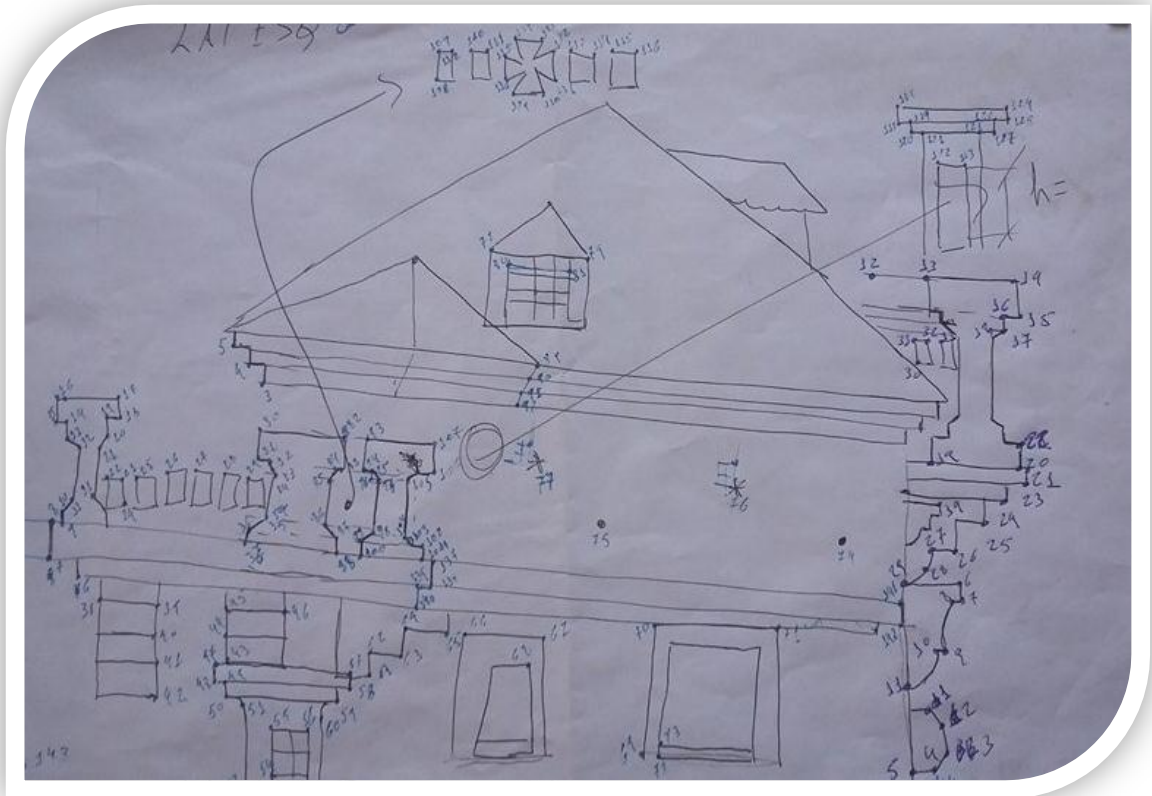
Pormenor do esboço da fachada do edifício, com pontos a recolher
